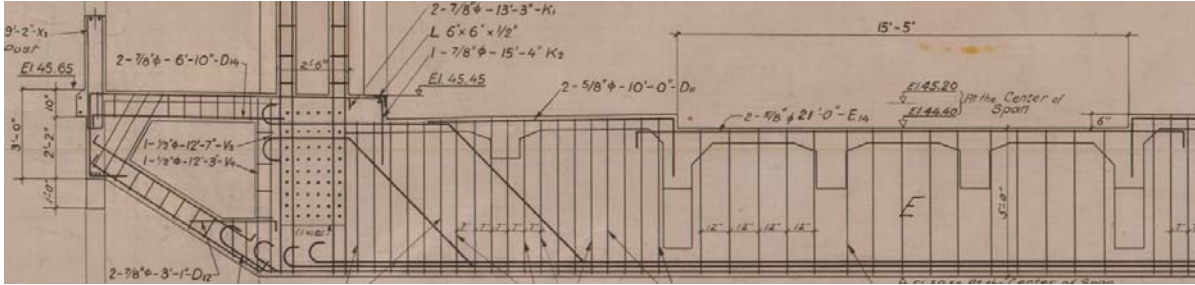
Armature des poutres transversales, provenant des dessins originaux du pont
